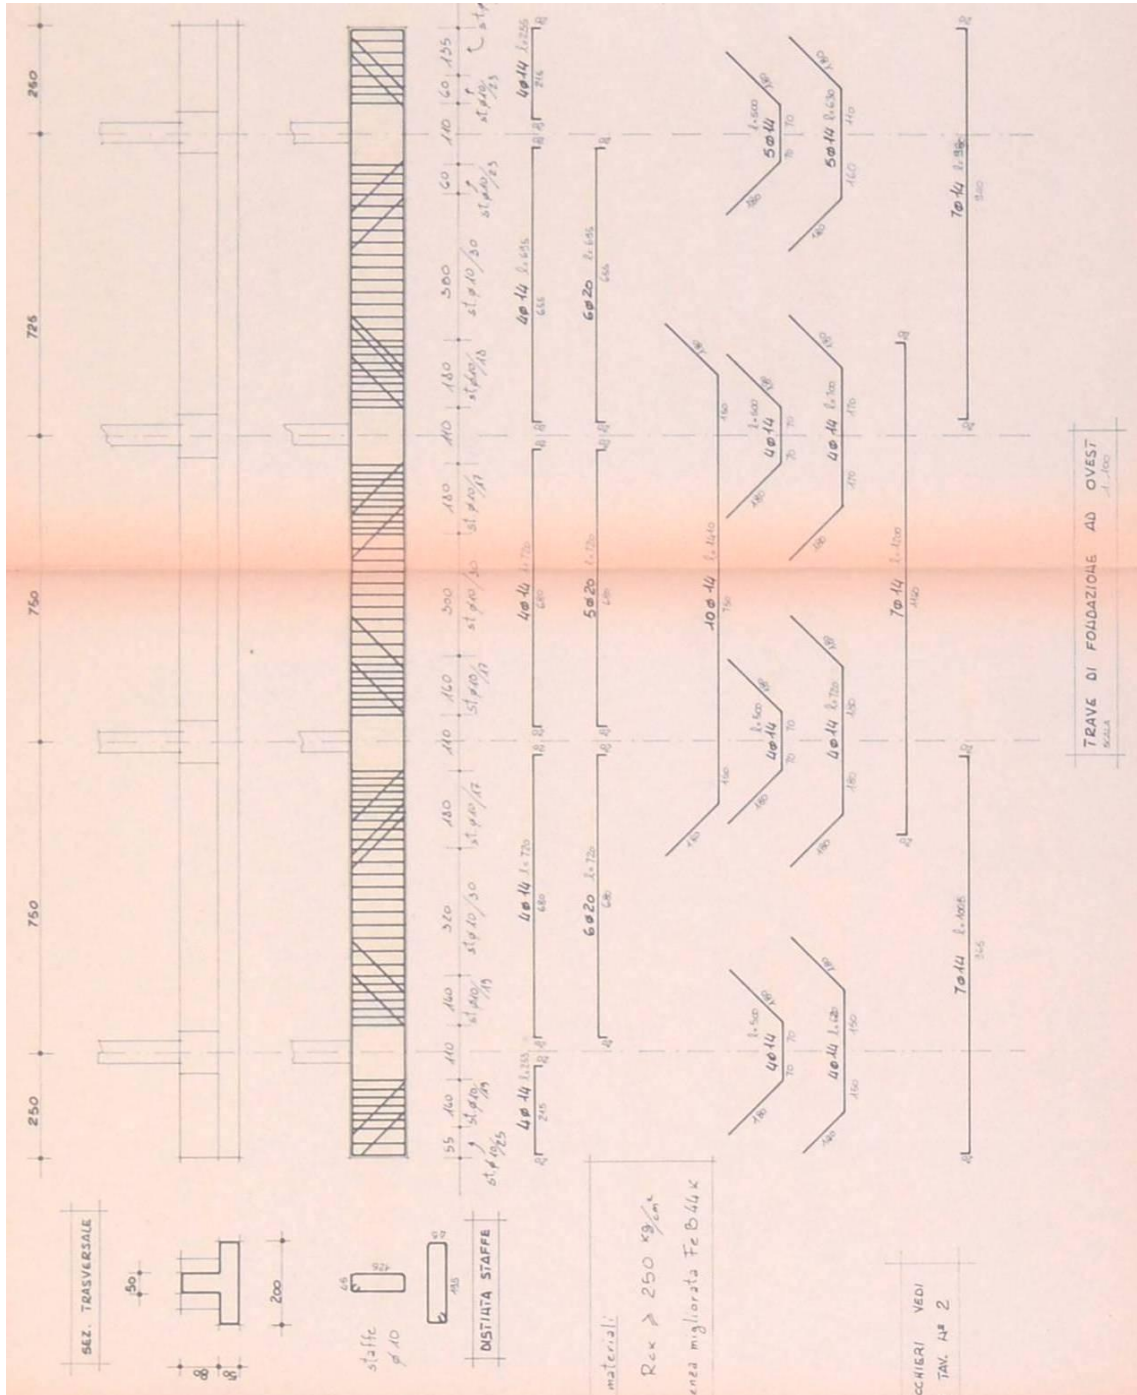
Particolare di A.1990.cap.us.T08 - Particolari delle travi di fondazione - Trave di fondazione Ovest
